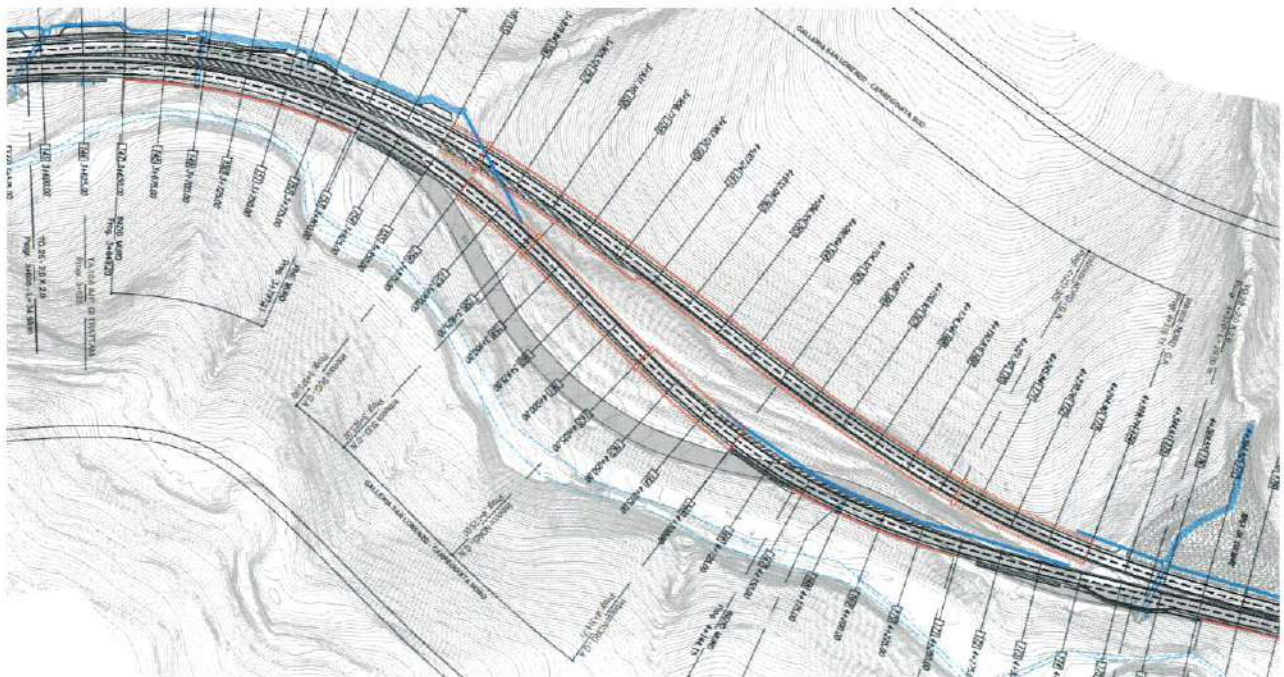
poggio San Lorenzo. Galleria. Planimetria di progetto tav.3 (sotto) (P01PS00TRAPL03A)
